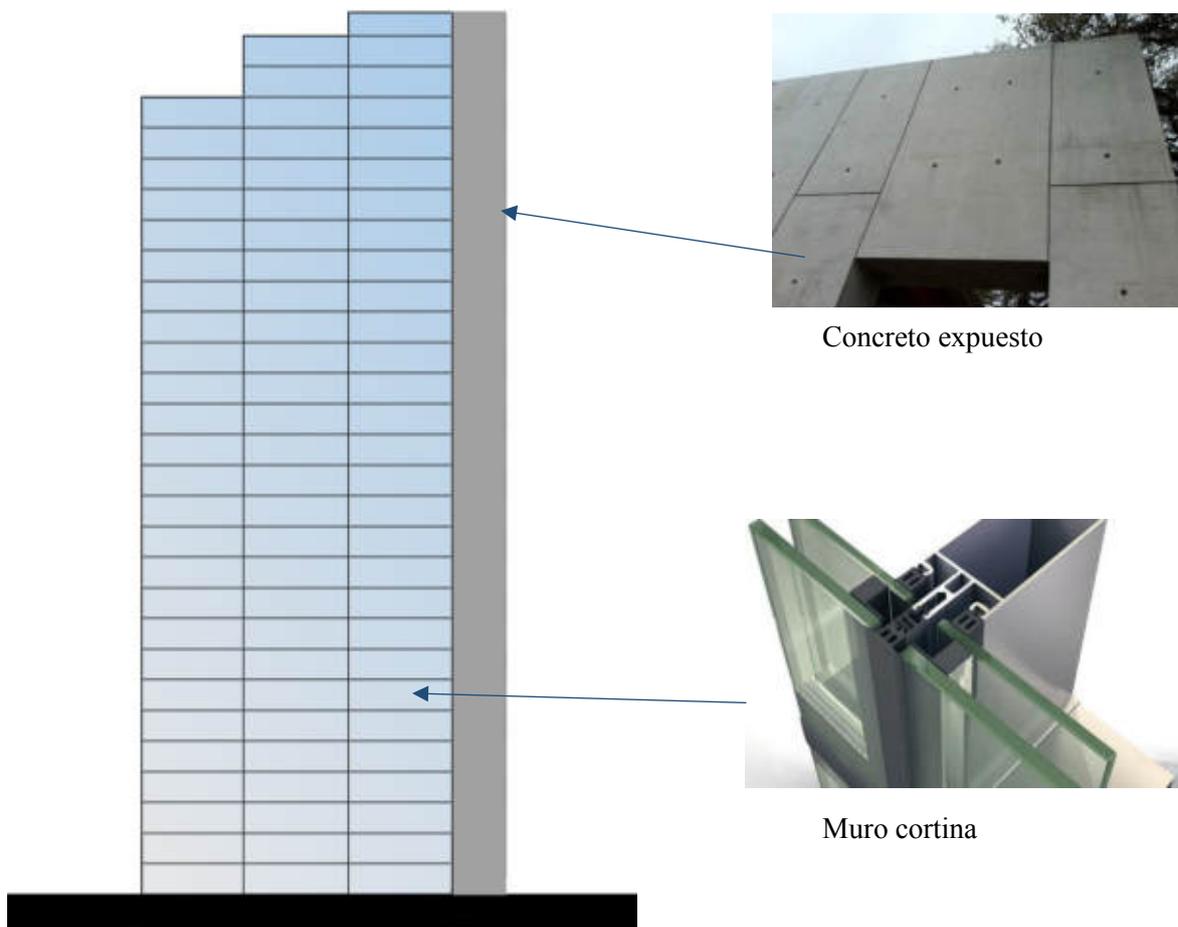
Materiales a utilizar en el proyecto arquitectónico. Fuente: Elaboración propia.
